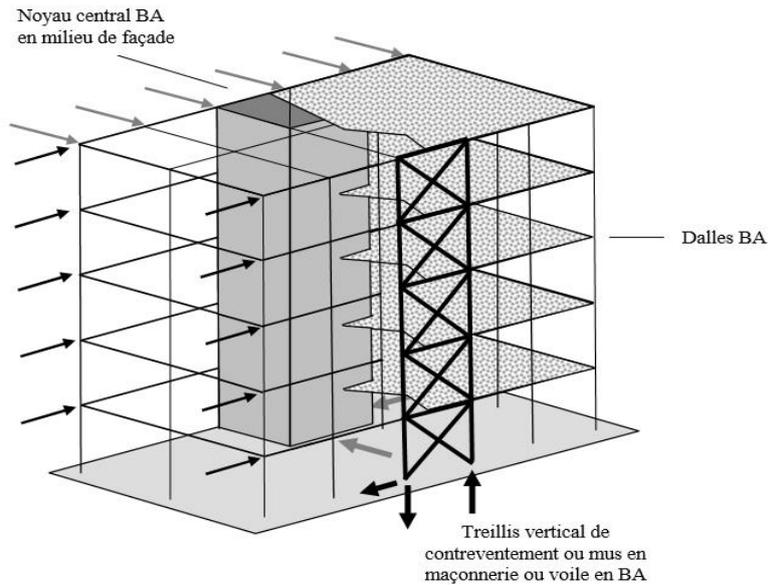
Stabilisation d'un bâtiment à étages par un Noyau central en béton armé
